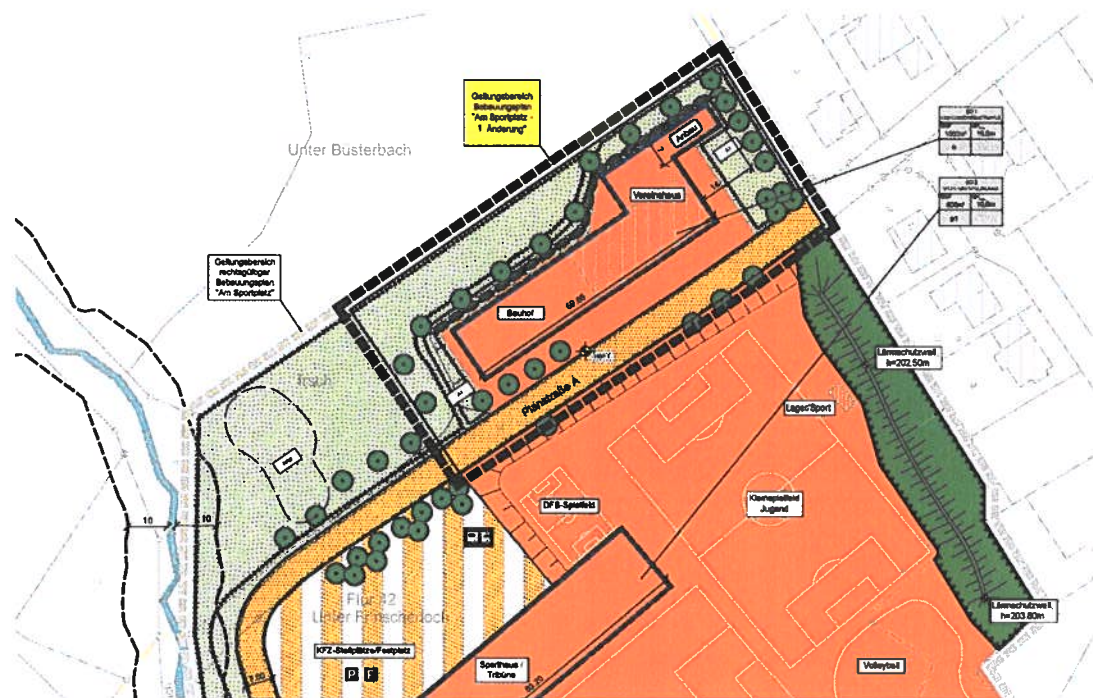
Planbereich Bebauungsplan „Am Sportplatz- 1. Änderung“, o.M.
